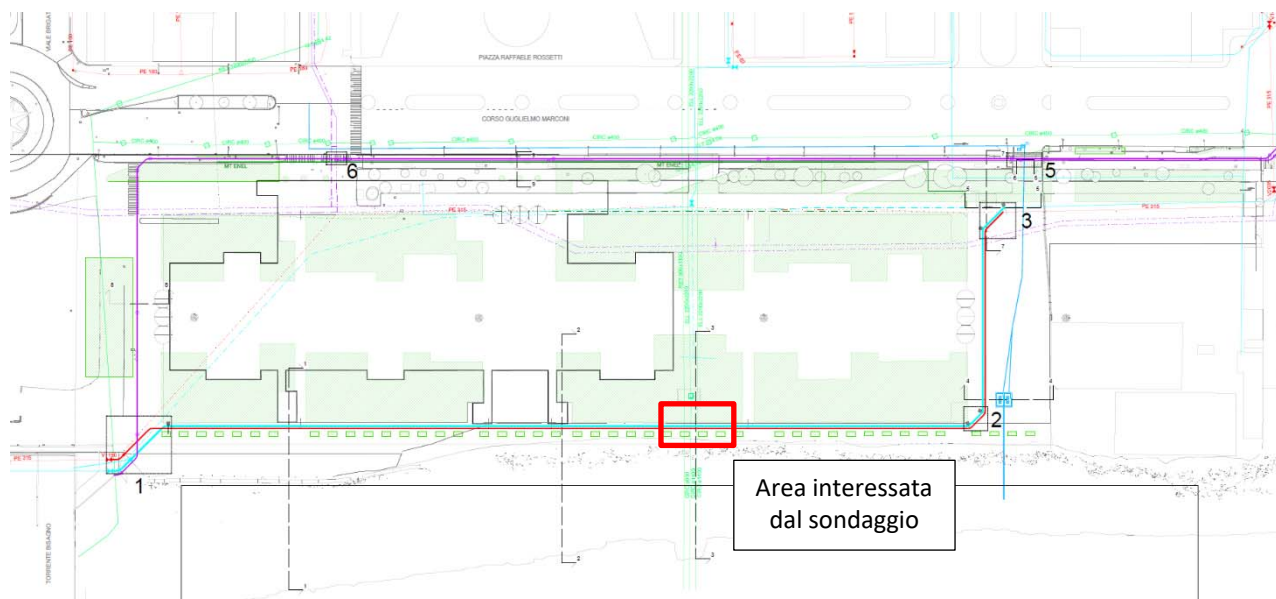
Tracciato attuale delle reti bianche (in verde) e individuazione area interferente con tracciato reti a progetto
